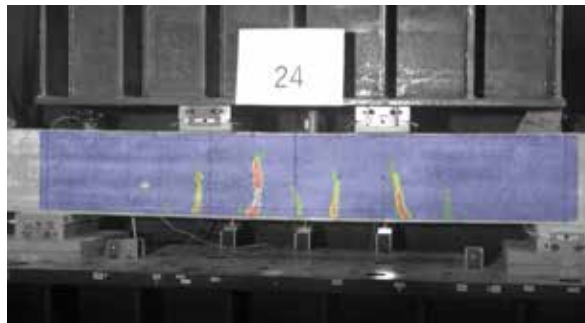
画像解析によるコンクリートひび割れの可視化
